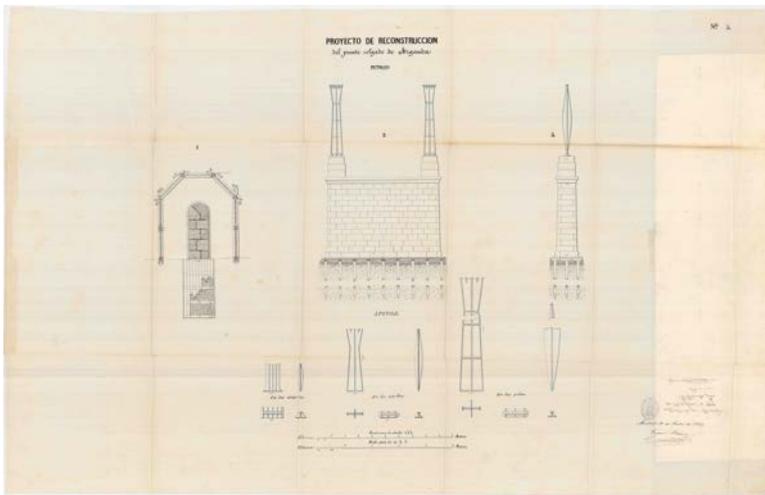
[España] Ministerio de Cultura y Deporte. Archivo General de la Administración, Signatura 24-02469, Plano nº 5 de detalles de las piezas de fundición que forman los apoyos para la reconstrucción de la pila (Ingeniero Eugenio Barrón, Madrid, 10 de julio de 1859).
